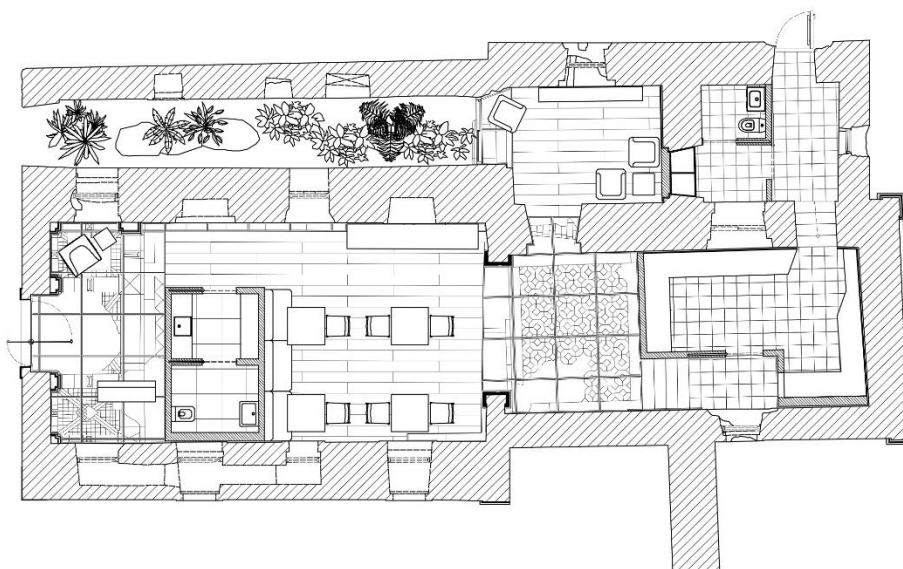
Planta proposta da capela de São Sebastião; Fonte: Autores.
